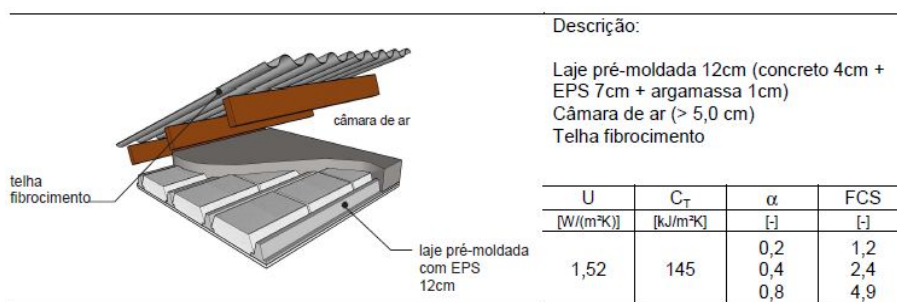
Telhado de fibrocimento com laje pré-moldada 12,0cm feito de concreto, EPS e argamassa (LabEEE 2010)
